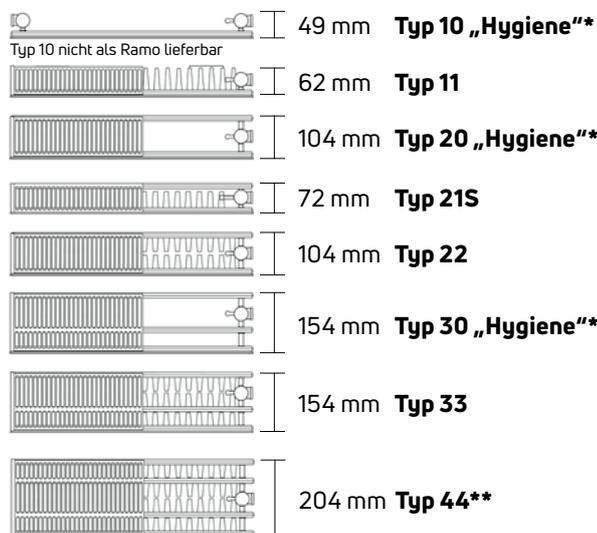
Übersicht Plan Ventil Compact und Ramo Ventil Compact 6-Muffen-Planheizkörper
